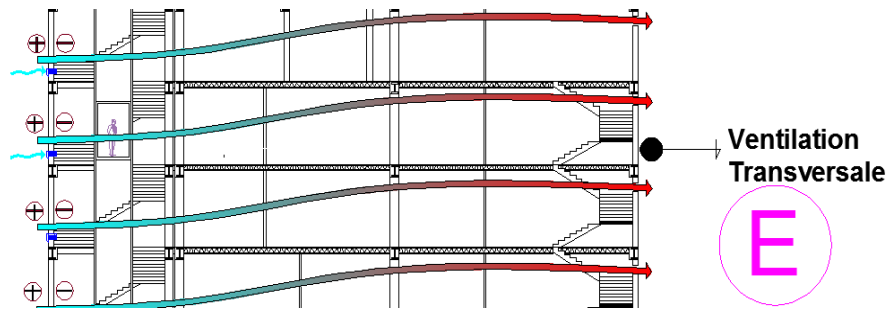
Zoom sur la ventilation traversante coupe CC Source : Auteurs
